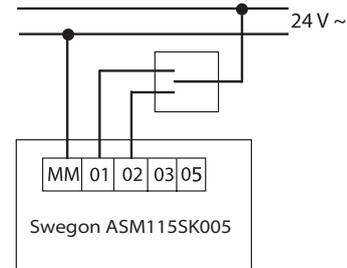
Schaltschema für SLJ -EM - Motorsteuerung mit 3-Punkt-Regelung. Schalter nicht enthalten.
